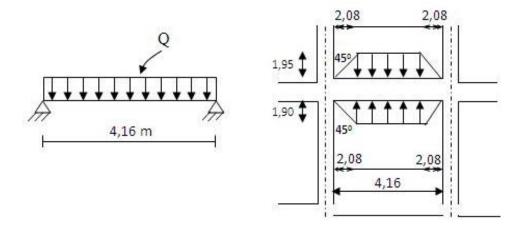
Répartition des charges sur les poutres selon les lignes de rupture.
